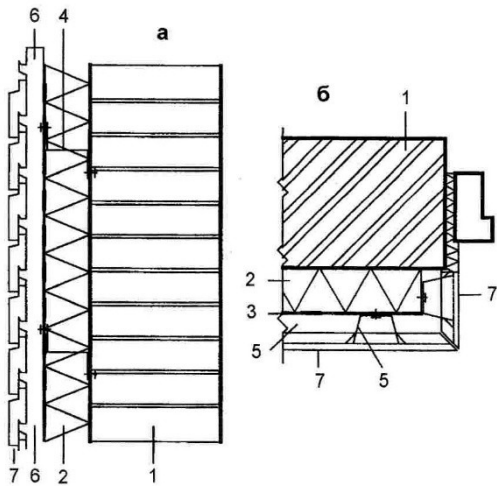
Цегляна стіна з навісною фасадною системою теплоізоляції з вентиляльованим повітряним прошарком і опорядженням індустріальними елементами:
